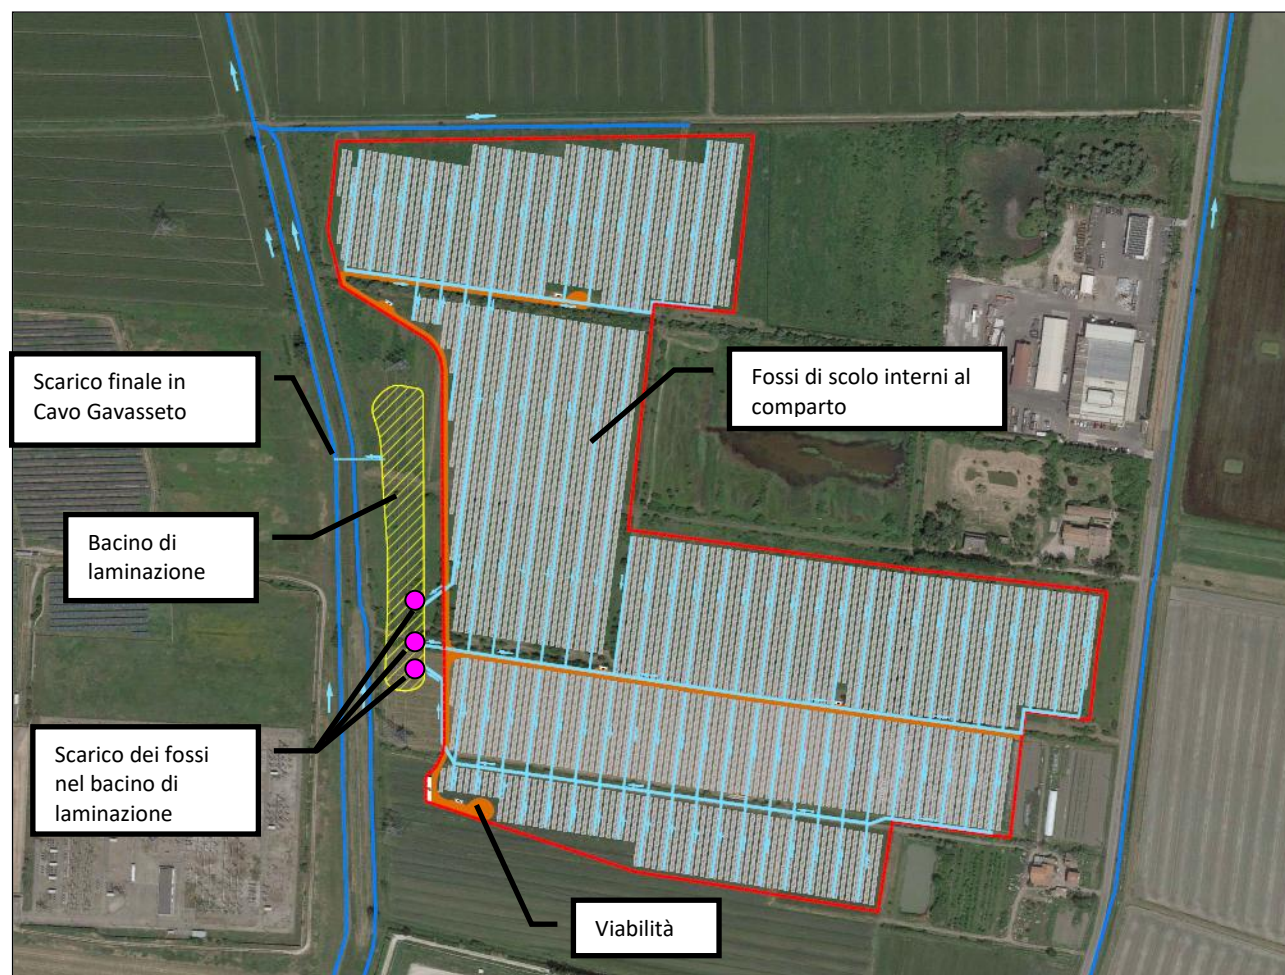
Schema della rete di drenaggio in progetto (Area Est).
